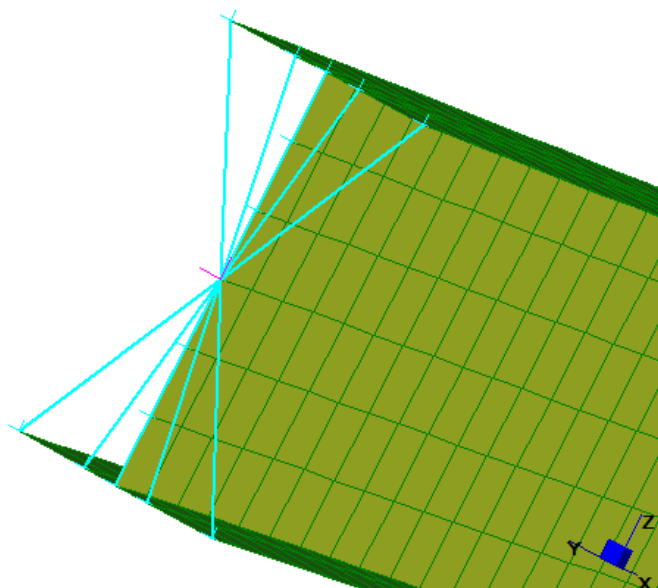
Restricción en el eje z aplicado en las caras de las vigas. Conexión 2.
